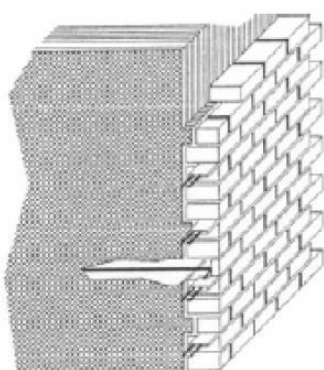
Exemplo de refechamento de juntas com armadura
